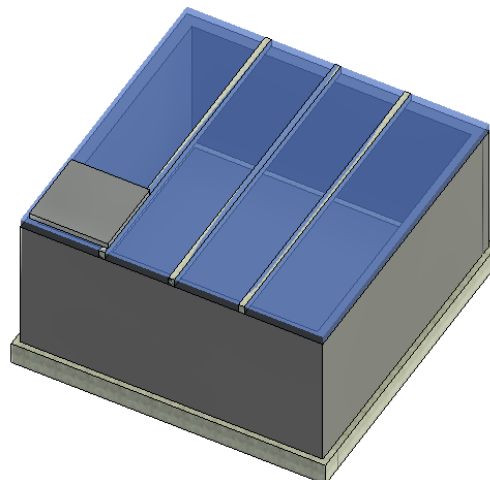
Vista en planta desarenador sistema Palo Largo.
